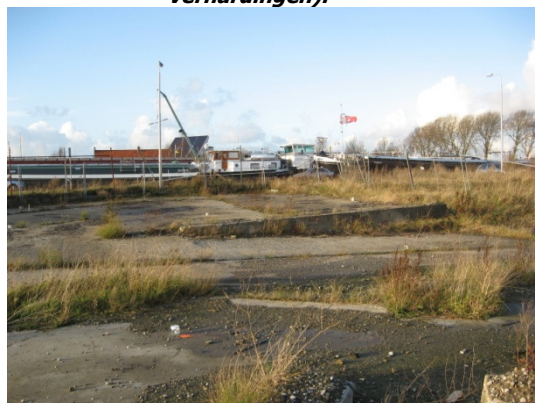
Foto kijkend naar zuidoostelijke richting (met verhardingen).
